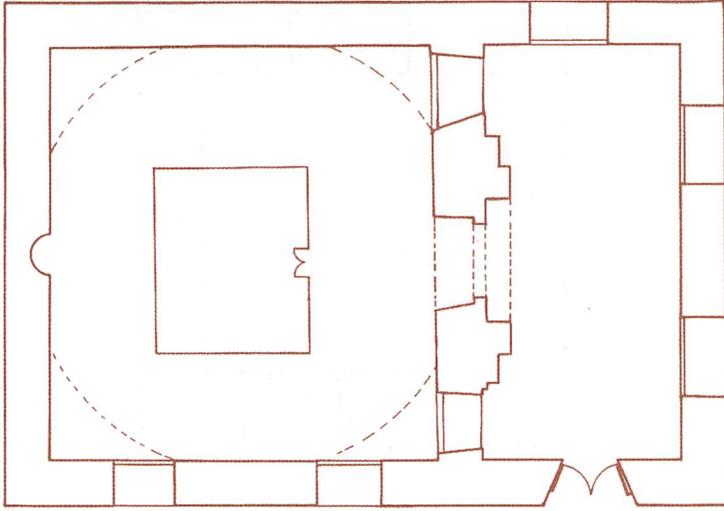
المسقط الأفقي لقبة وضريح العربى برشيد
